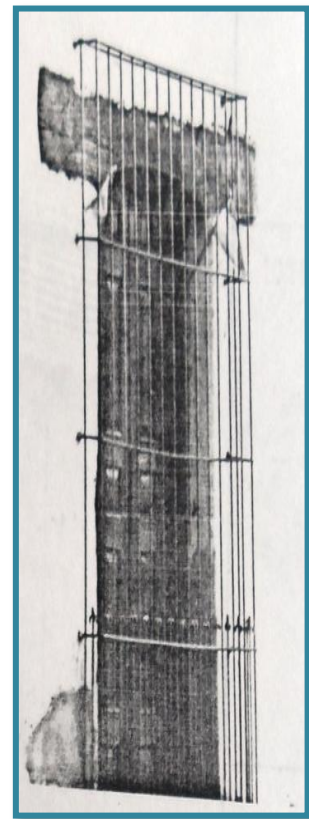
Fachada de edificio comercial sobre la 6ª calle Poniente con Dintel y pilastras
